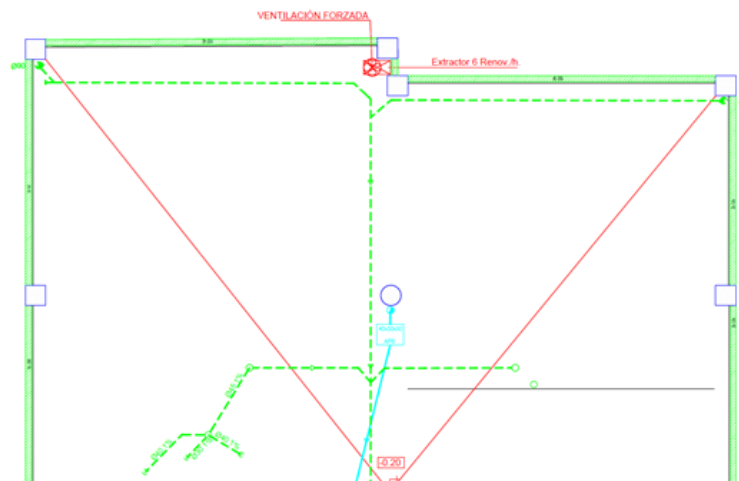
Instalación de saneamiento en planta de garaje. Fuente: Proyecto original.
